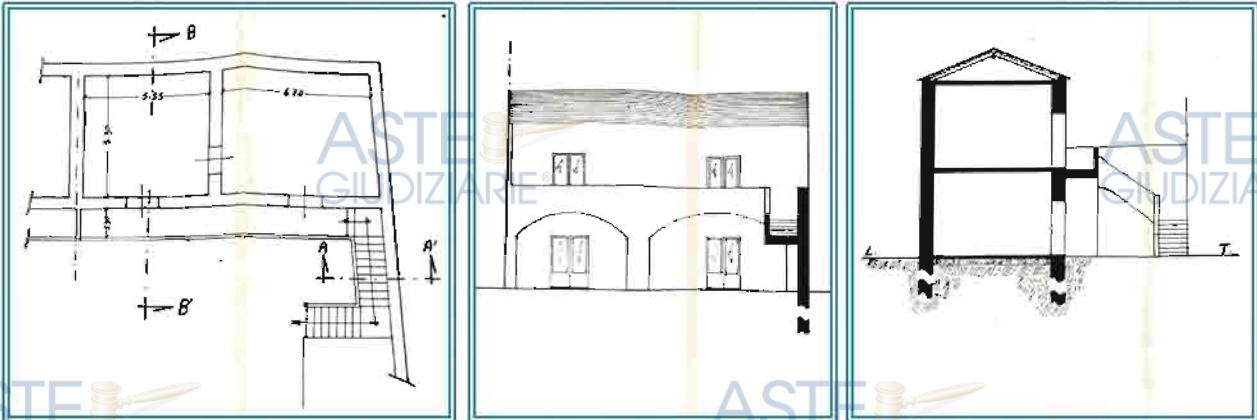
Pianta piano primo, Prospetto e Sezione (ante operam) – estratto dal fascicolo n. 5951 del 17.03.1988
